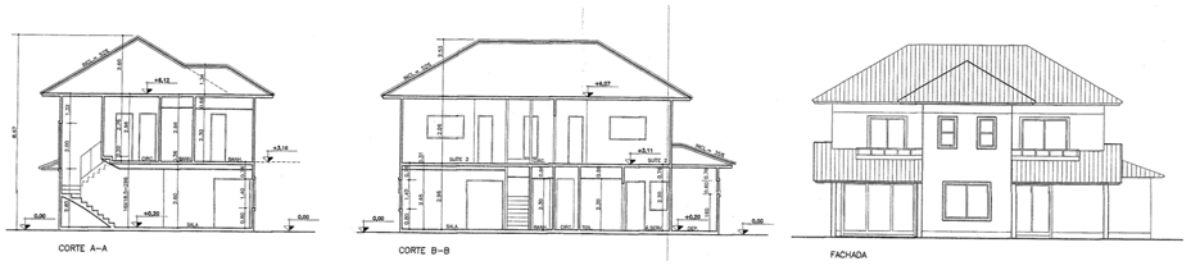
Destaque dos cortes e fachada – modificação de projeto aprovado na SMU
